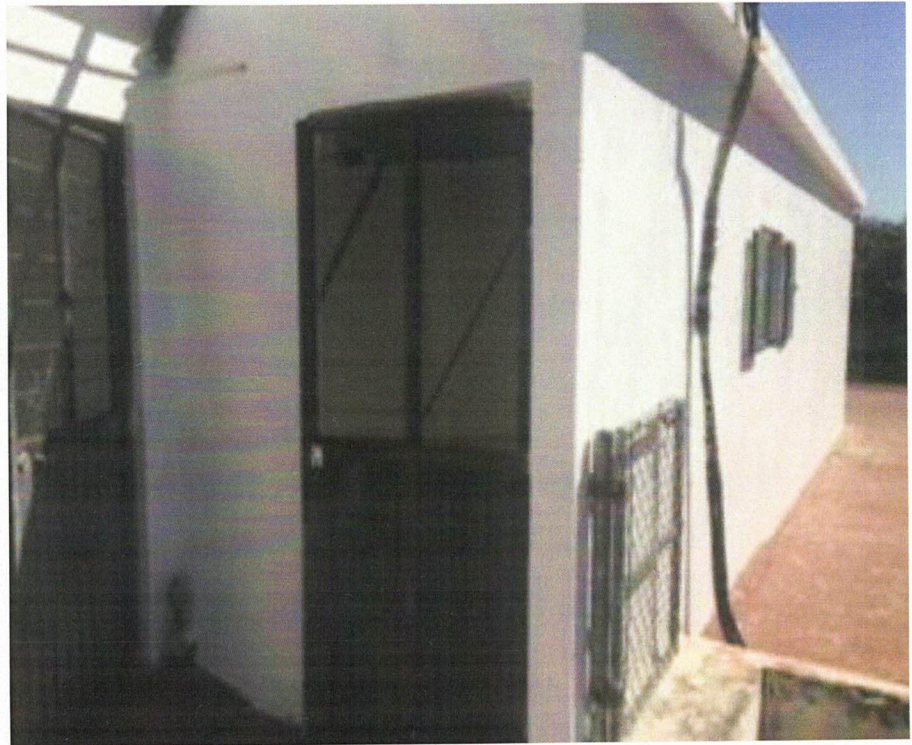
CONSTRUCCIÓN AZOTEA: EL INMUEBLE CUENTA CON UNA BODEGA EN LA AZOTEA EN MAL ESTADO DE USO, NO CUENTA CON VITROPISO. PARA LLEGAR A ÉSTA BODEGA ES NECESARIO ASCENDER POR UNA ESCALERA METÁLICA TIPO CARACOL EN LA PUERTA DE ACCESO QUE ESTÁ ENTRE EL DESPACHO 1 Y DESPACHO 2 DE PLANTA ALTA.
